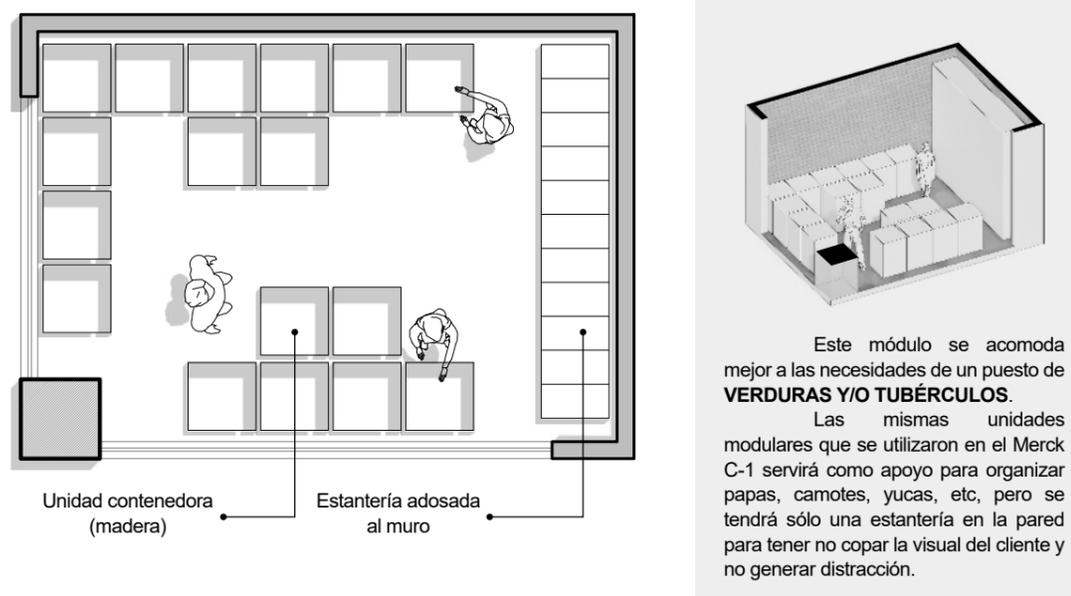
Planta módulo Merck C-6 Fuente: Elaboración propia
